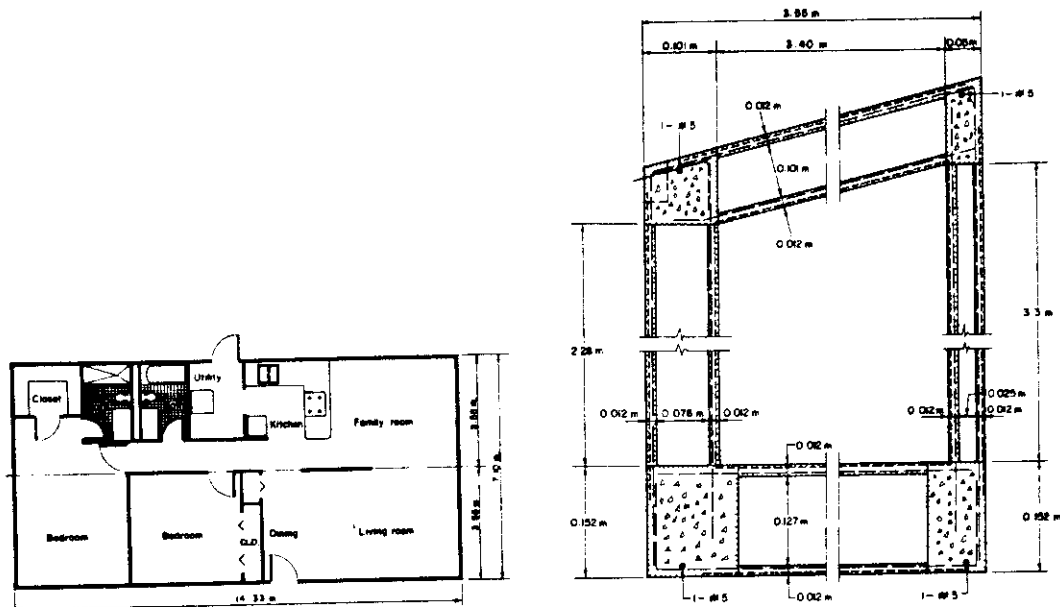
PLANTA BAIXA DO PROTÓTIPO E JUNTAS CONSTRUTIVAS.
